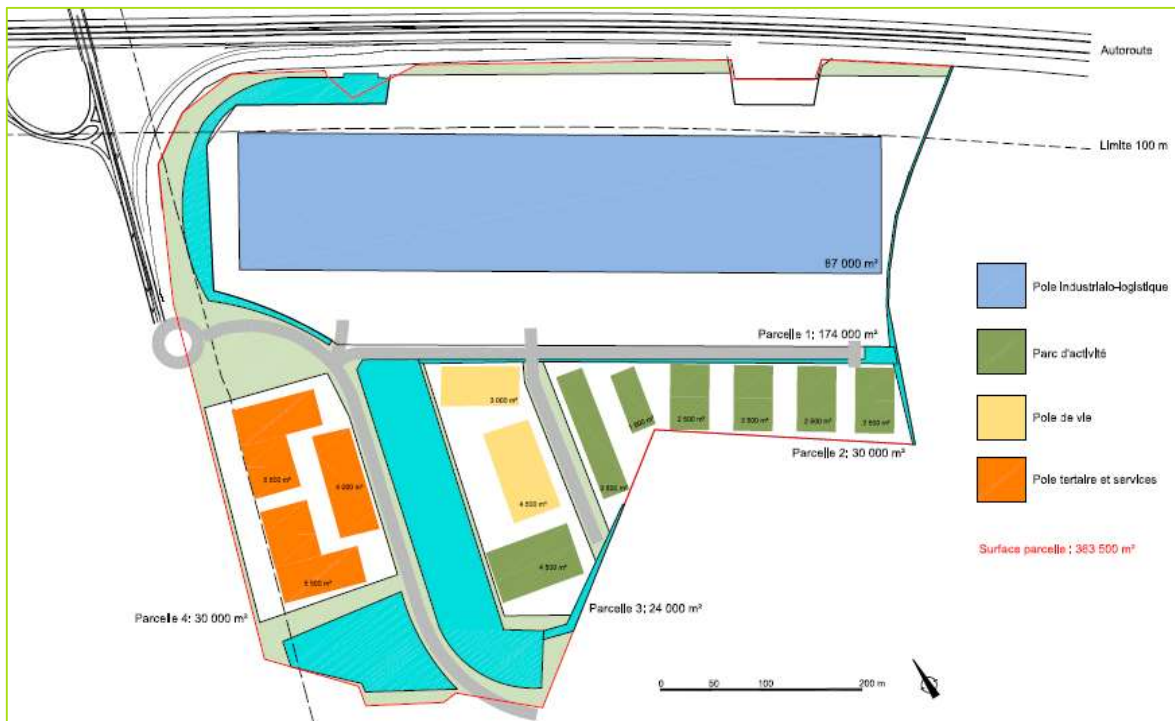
Plan masse RETENU du 01 février 2022 (Source : Espace Libre/SUEZ Consulting)
